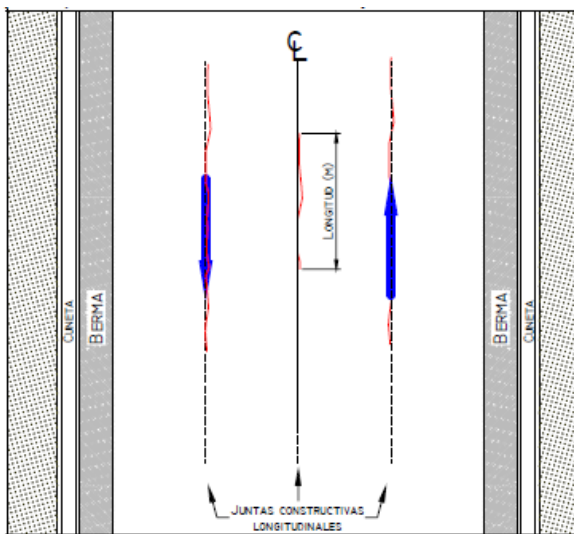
Fisura de construcción longitudinal sobre pavimento asfáltico existente
